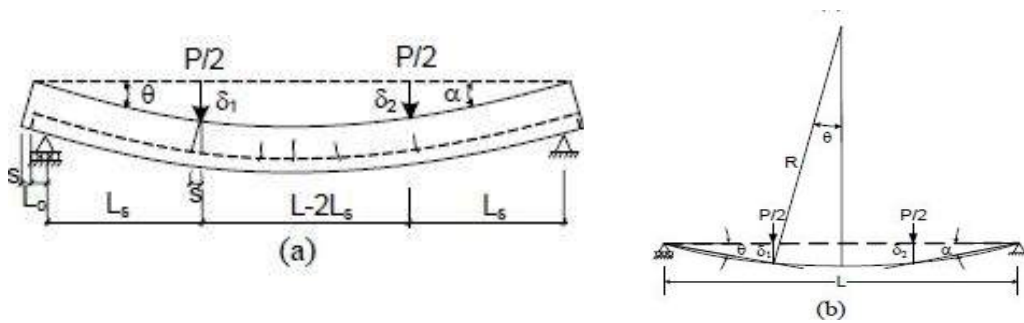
Fissuração da laje ensaiada (a); Deslocamentos e curvatura da laje ensaiada (b) (adaptado de [18])
